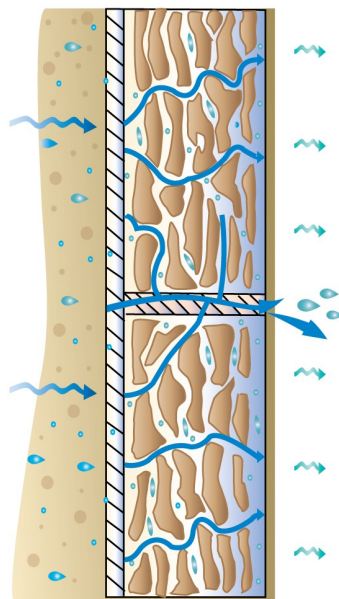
Struktura wewnętrzna i zachowanie wody w płytkach prasowanych
